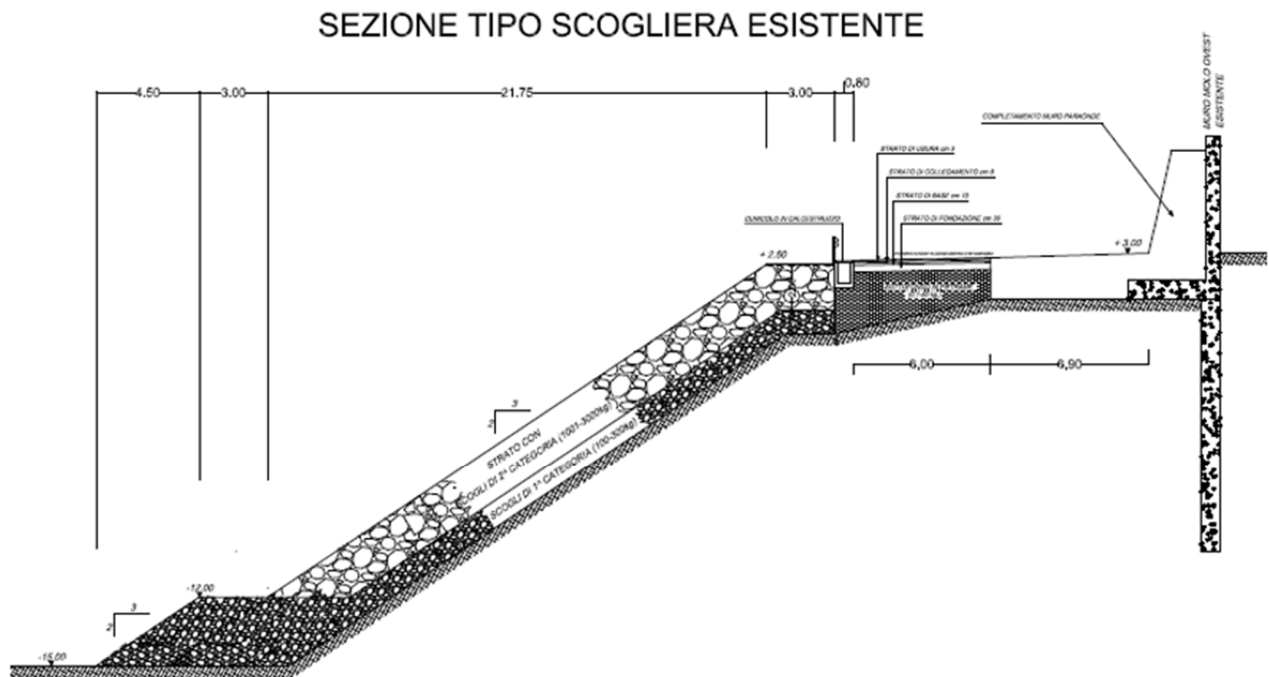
Sezione corrente della scogliera a protezione della sponda di ponente del canale portuale
